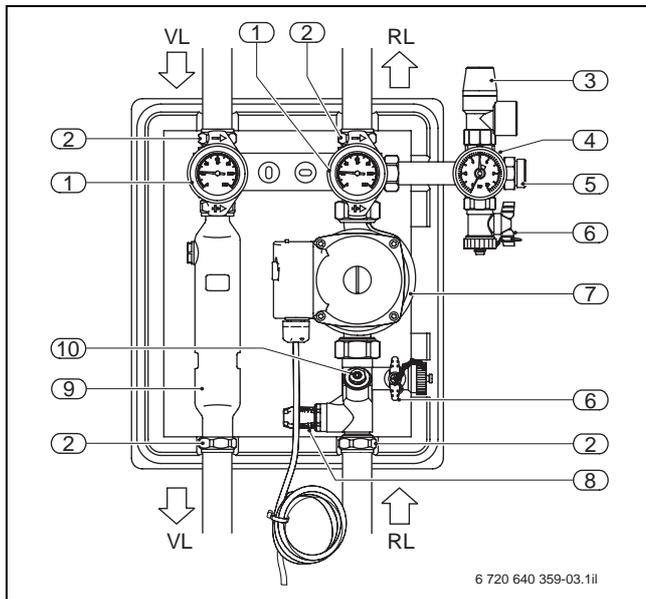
Struttura Logasol KS01... senza termoregolatore per circuito solare integrato; dimensioni e dati tecnici → pag. 17 e seguente
